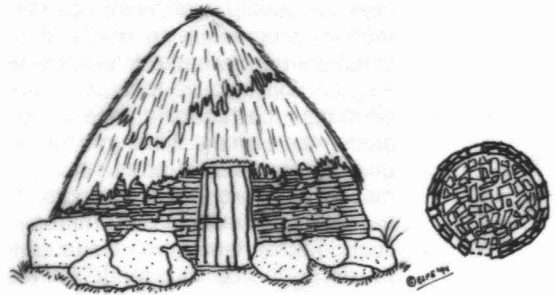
Planta y alzado de un chozo con enlosado y mampostería de pizarra.
